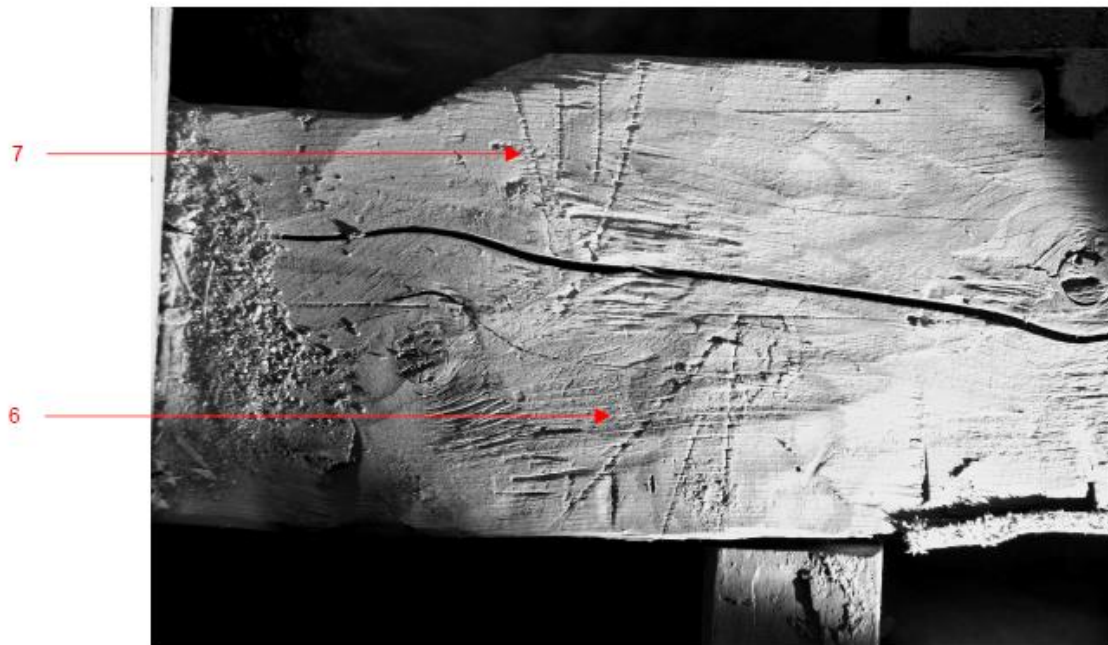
Nœud d'assemblage de l'entrait retroussé de la ferme principale 4 (T-13) avec les marques de numérotation des sections de contreventement qui s'y assemblent.
